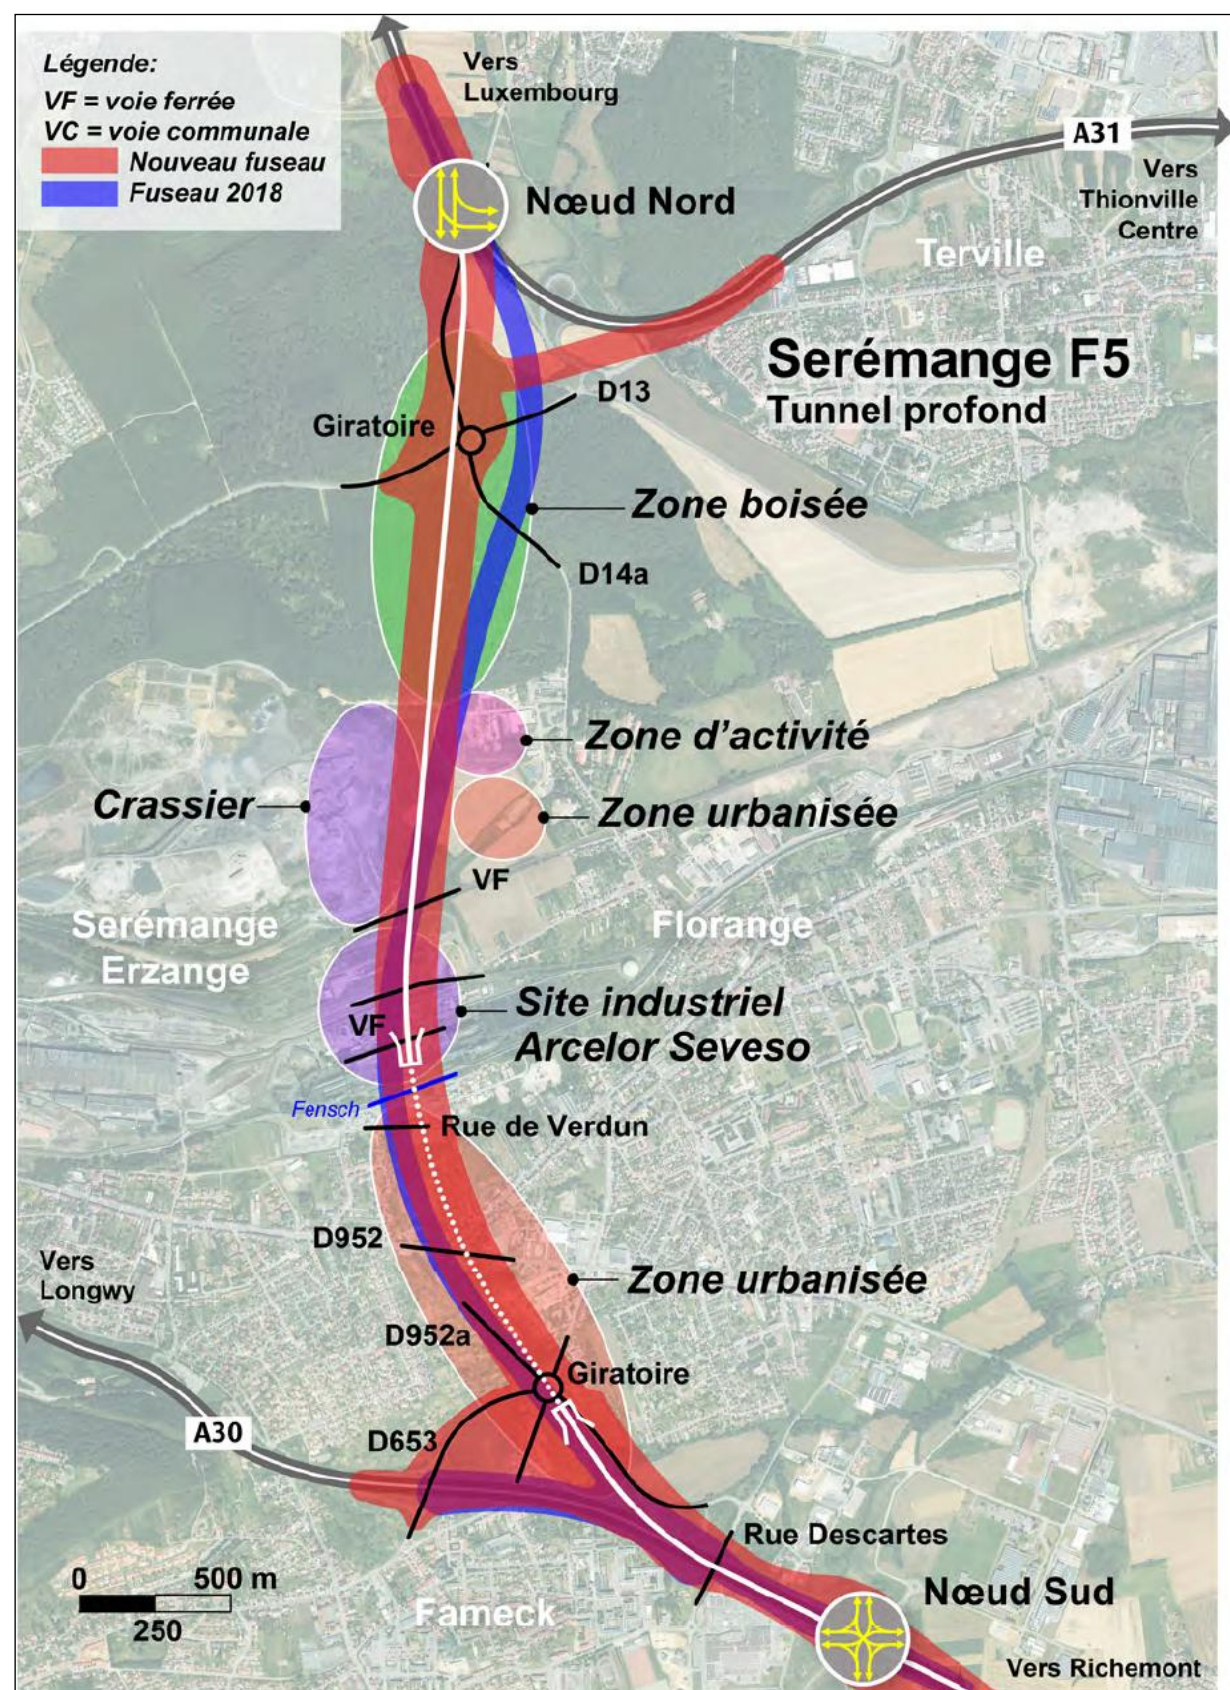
Tracé de la variante F5-Tunnel profond et des principaux enjeux
